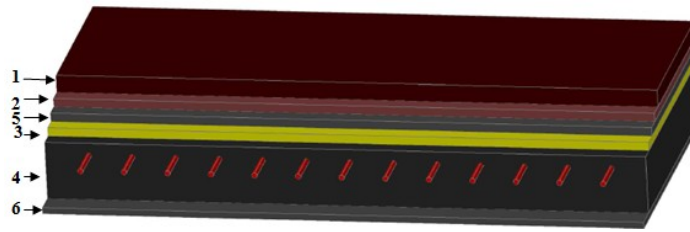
illustration 3D du plancher terrasse inaccessible en dalle pleine
